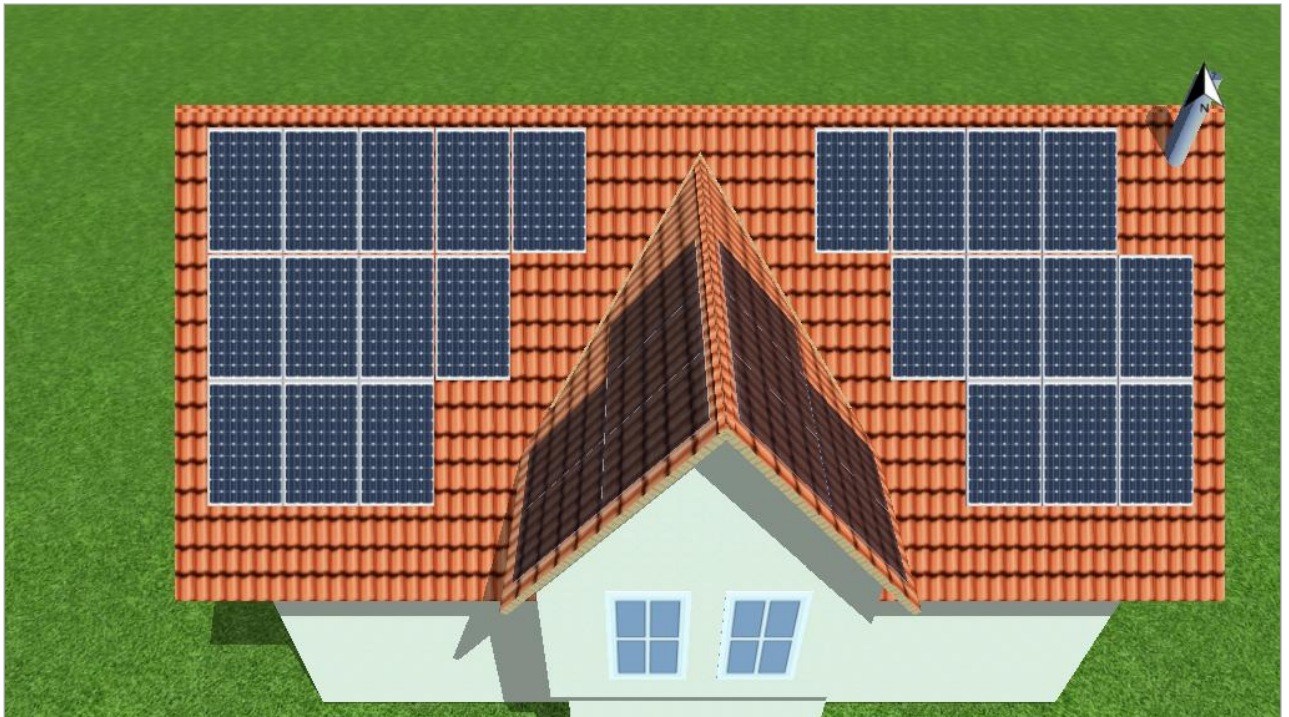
Modulfläche - Building 1-Roof Area South
